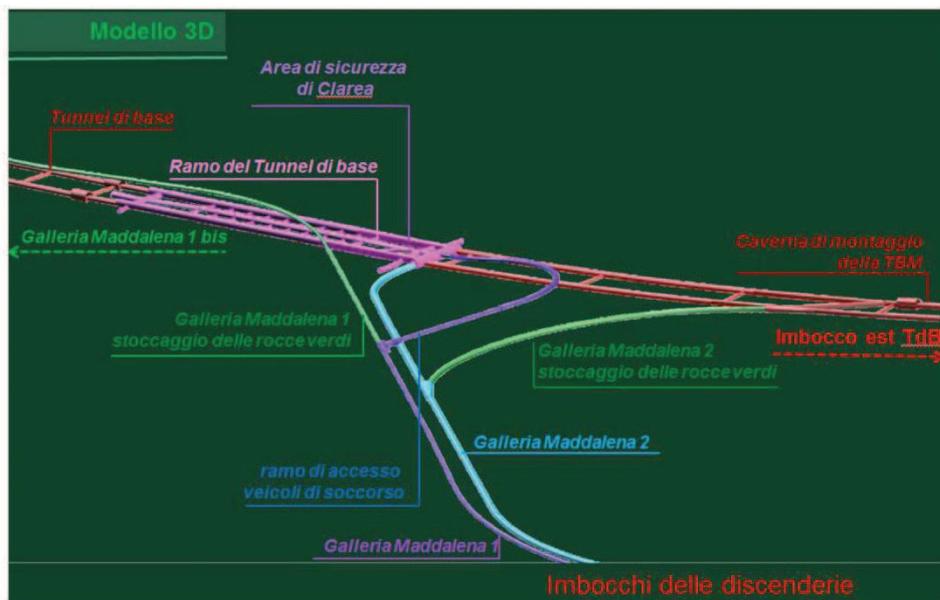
Modello 3D Tunnel di Base e siti di deposito sotterraneo pietre verdi
